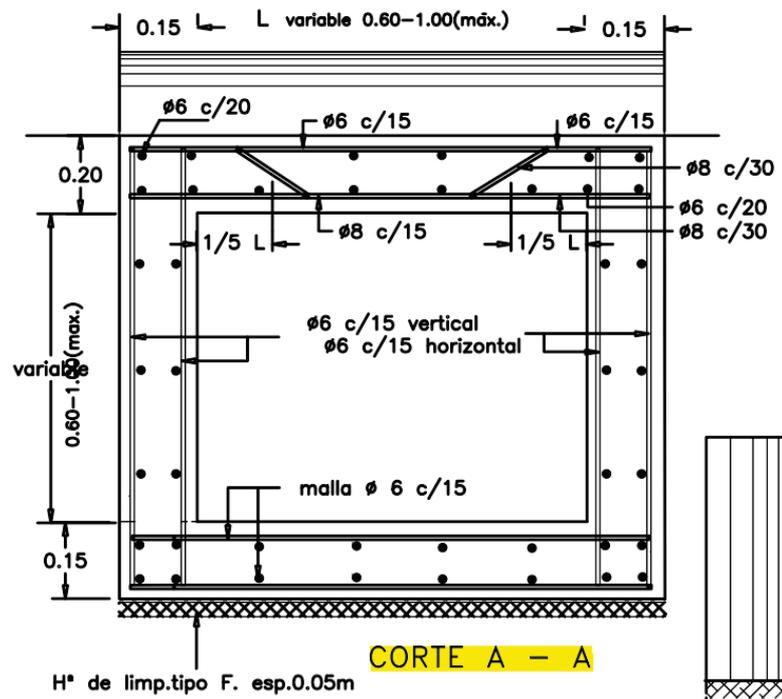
Plano Tipo. Alcantarilla A - 42 de DPV.
